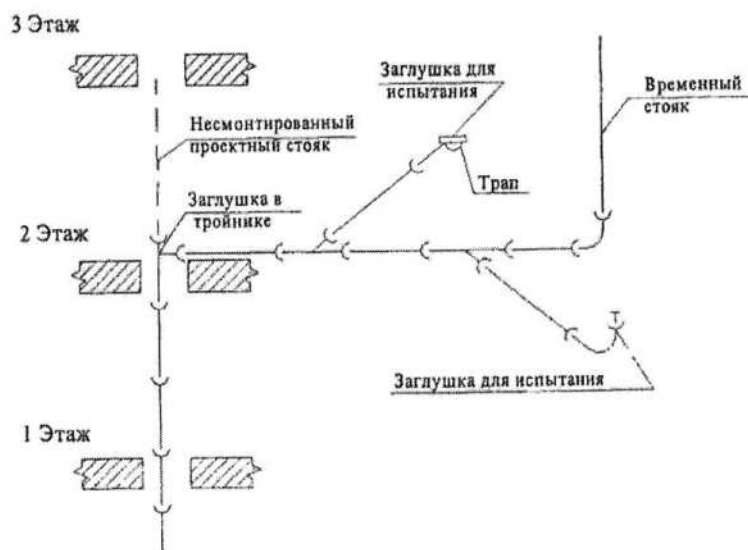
Схема гидростатического испытания отводных трубопроводов, проложенных в конструкциях междуэтажных перекрытий
